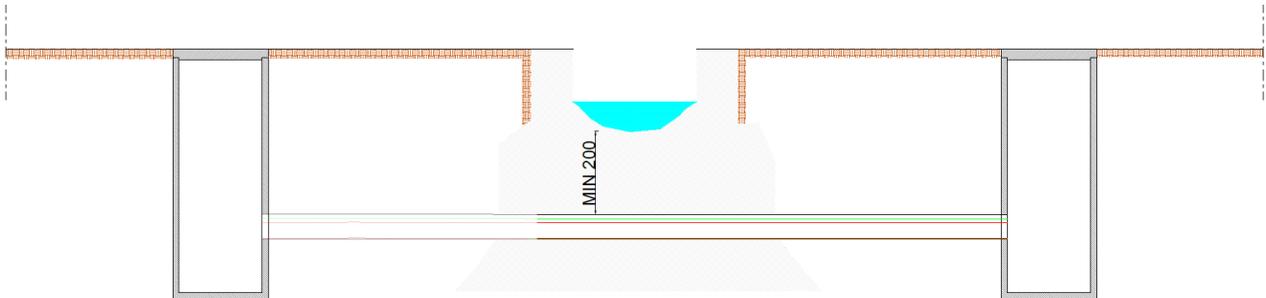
Sezione tipo cavidotto MT ed AT realizzato con tecnica spingi-tubo
